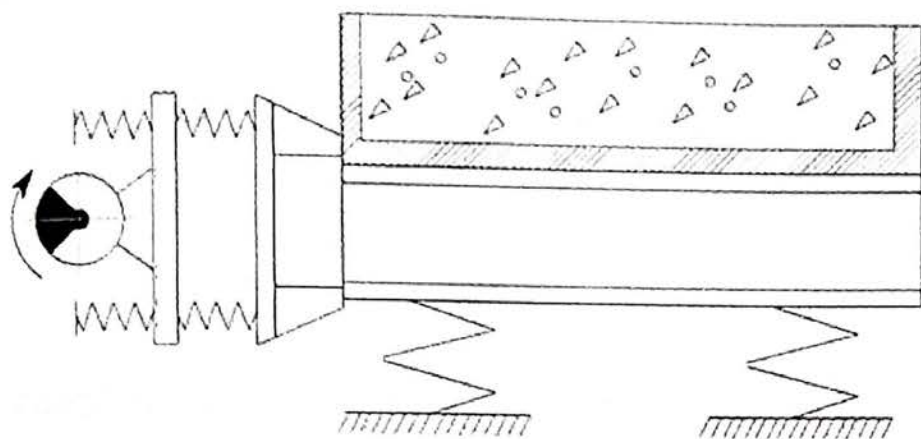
Віброустановка з направленими горизонтальними коливаннями
